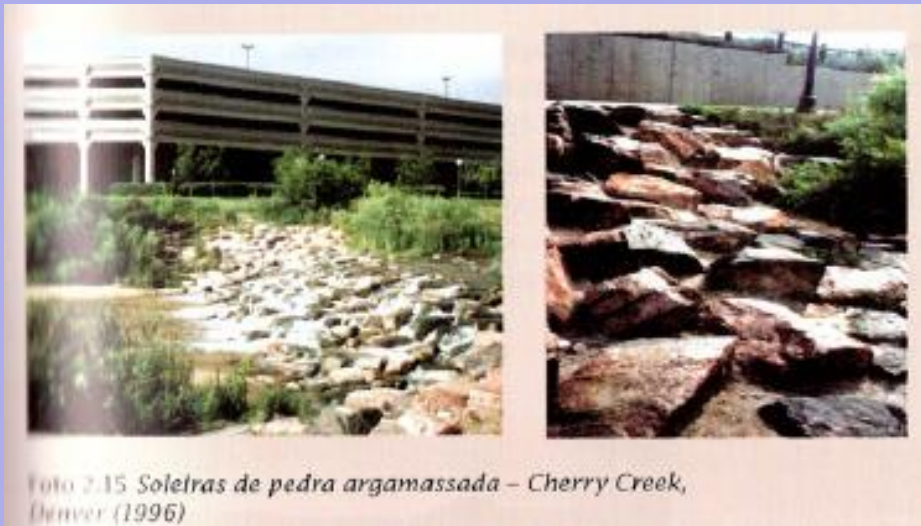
Soleiras de pedra argamassada - Cherry Creek,
